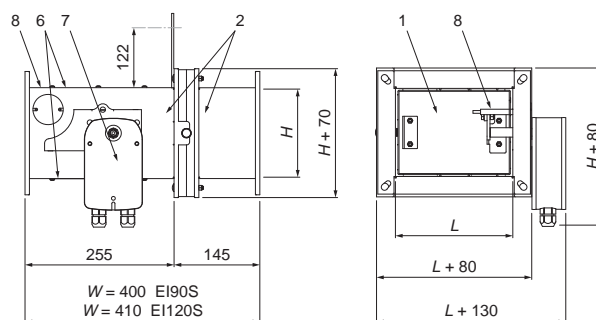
Конструкция малоразмерного противопожарного клапана с электромеханическим приводом для размеров из табл. 4
